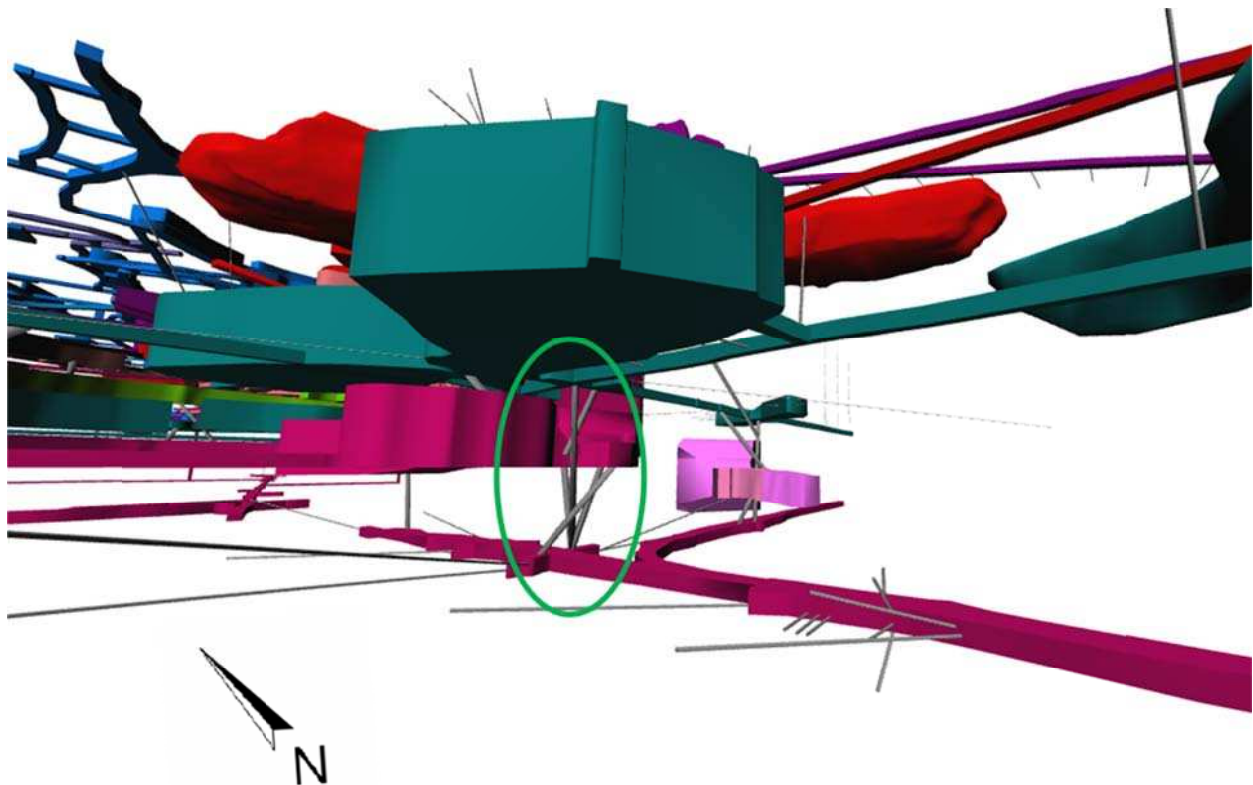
Detaildarstellung Lokation 3 (15YER22/RL008).
